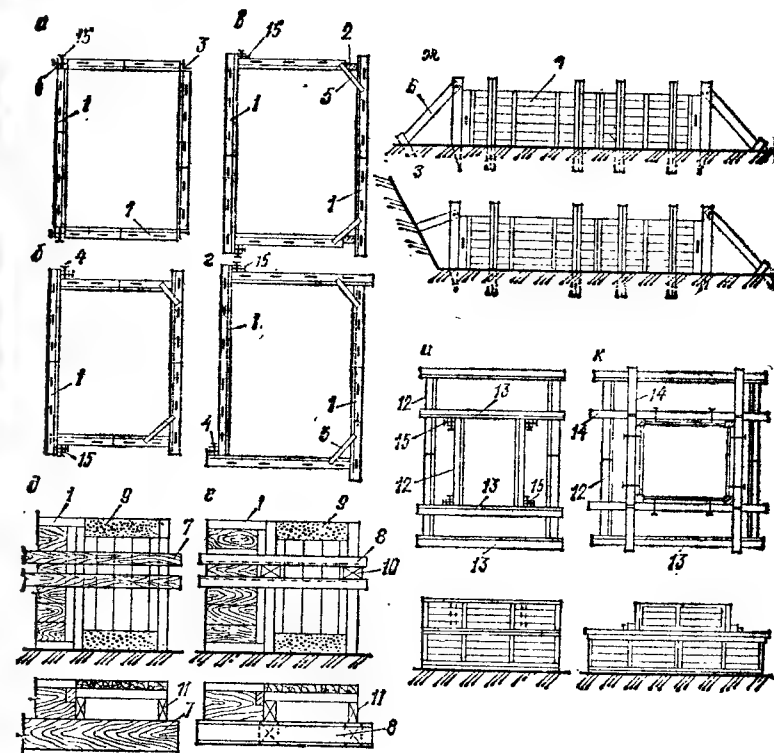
Сборка разборно-переставной опалубки ступенчатого фундамента
